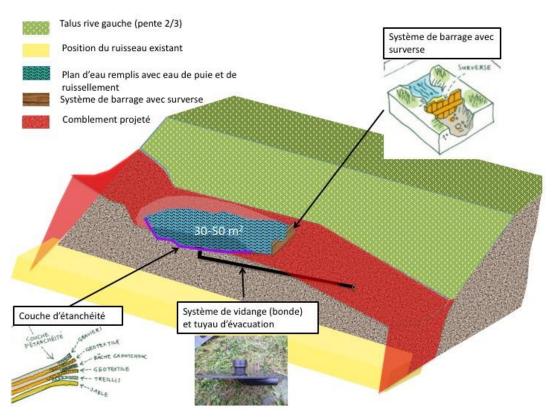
Schéma explicatif d'une construction de biotope pour batraciens
